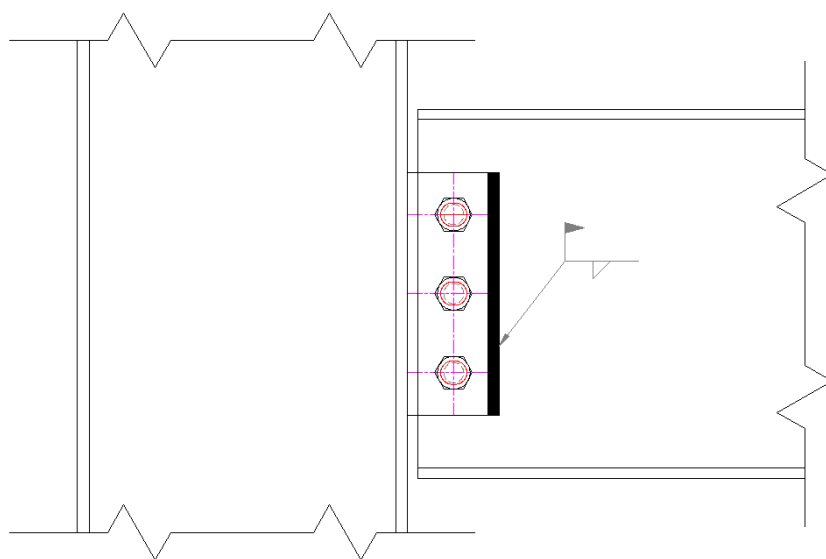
Ligação parafusada e soldada com esforço transmitido simultaneamente por parafuso e solda
